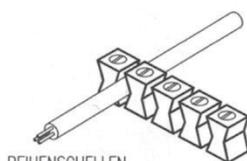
Befestigungstechnik (<https://www.airleben24.de/montagetechnik>, 14.02.2018, 11:38)
